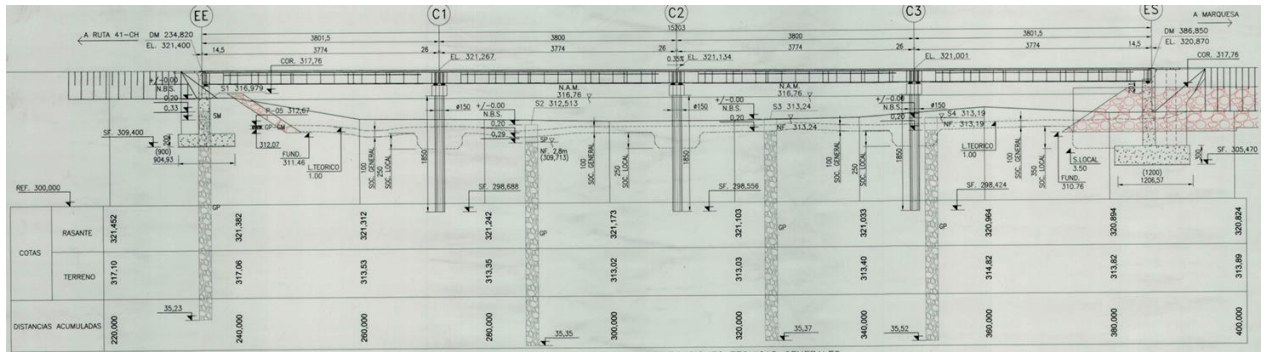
Plano perfil longitudinal Puente Marquesa.
